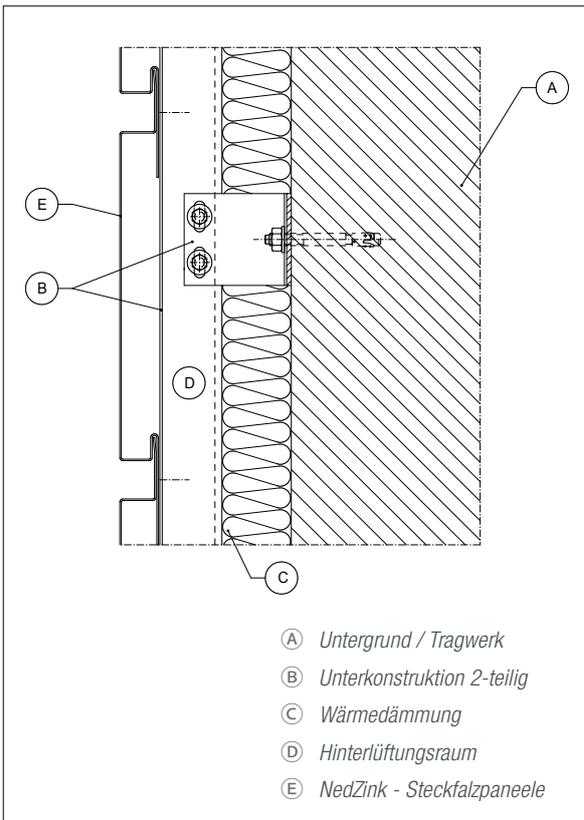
Steckfalzpaneele Fassadenschnitt
